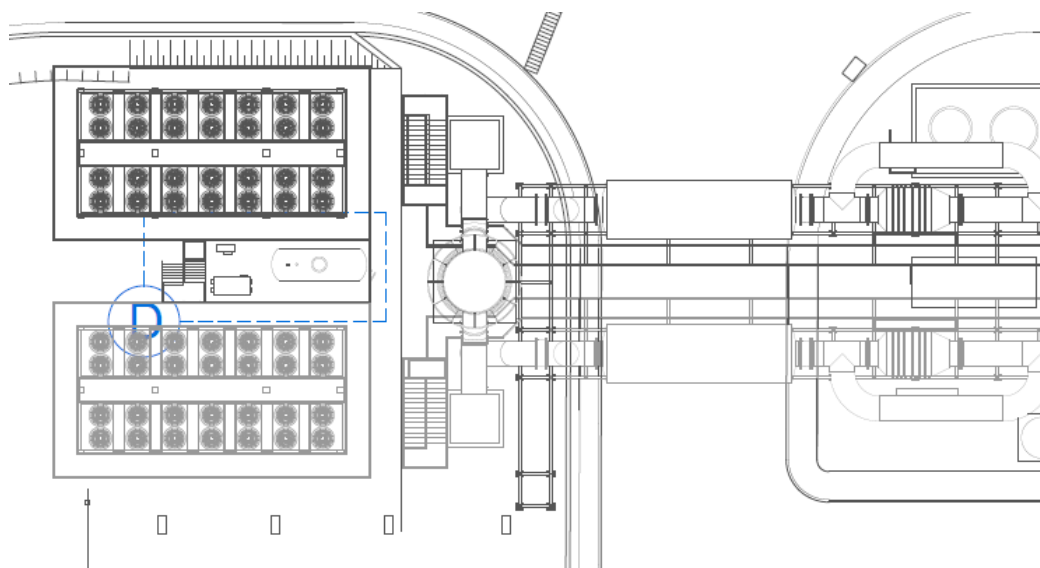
Implantação da Chaminé de exaustão, edifício (D) e ventiladores.
